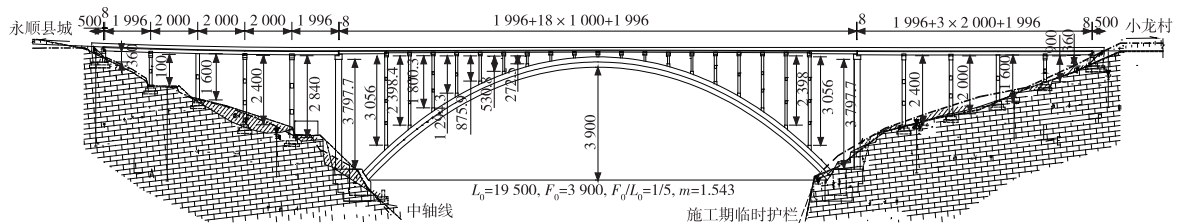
牛路河特大桥桥型布置立面图(单位:cm)
